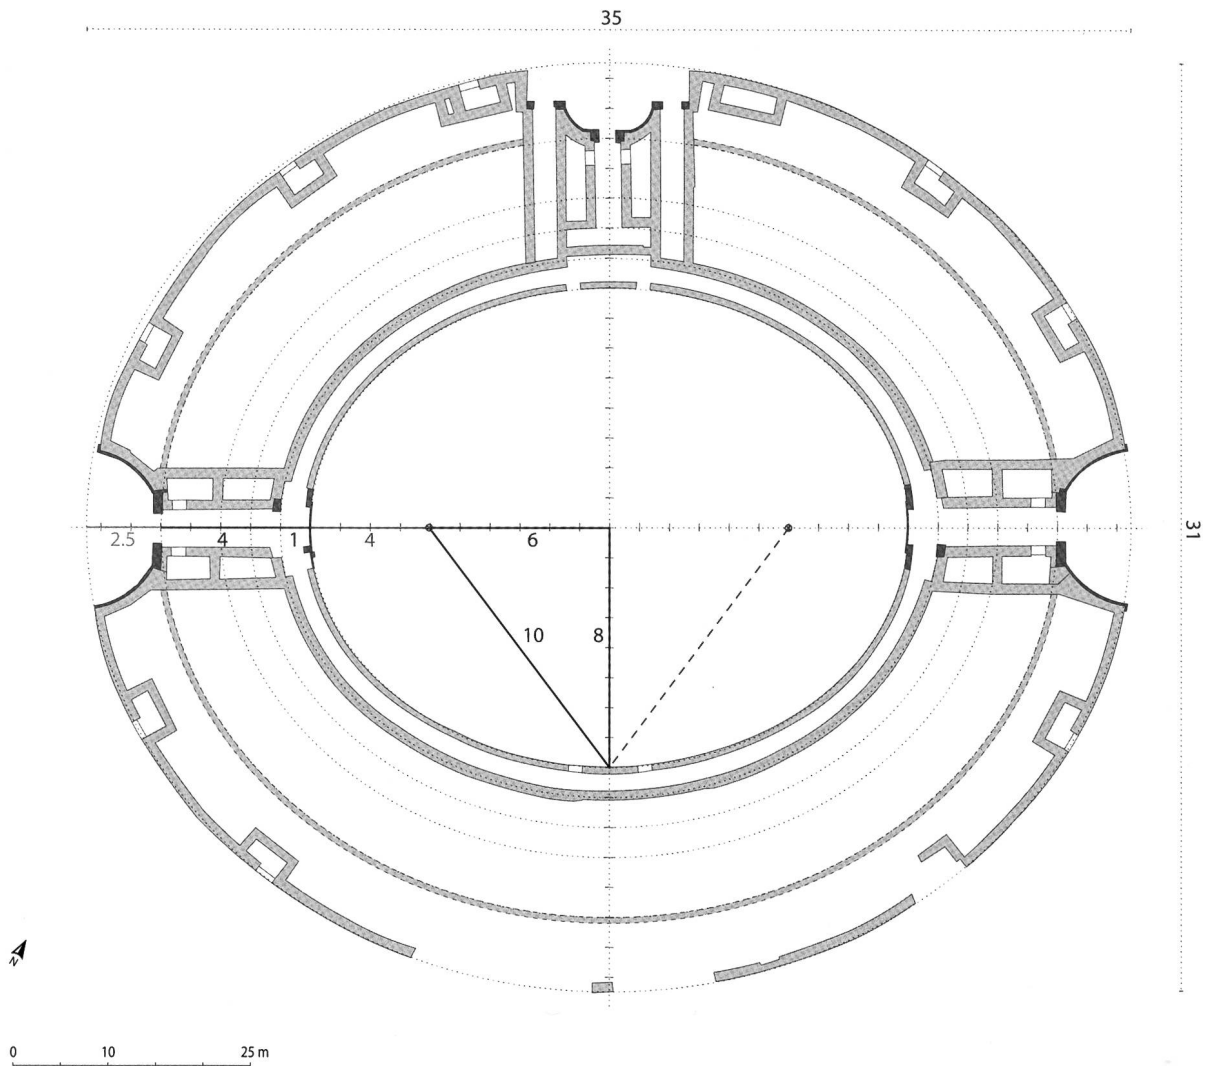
Amphitheater. Rekonstruierter Grundrissplan des Steinbaus mit theoretischer Planungsgeometrie (grün) und Modulierung (grün, blau, violett, braun, gelb). M 1:800.
